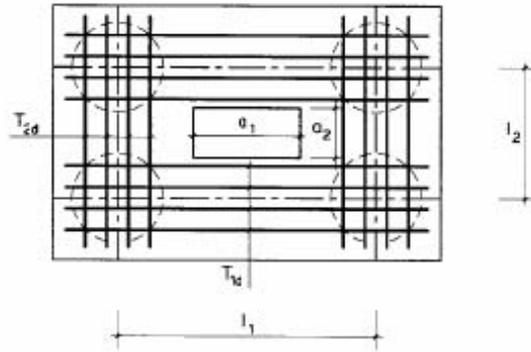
Armadura principal en un encepado de cuatro pilotes.
